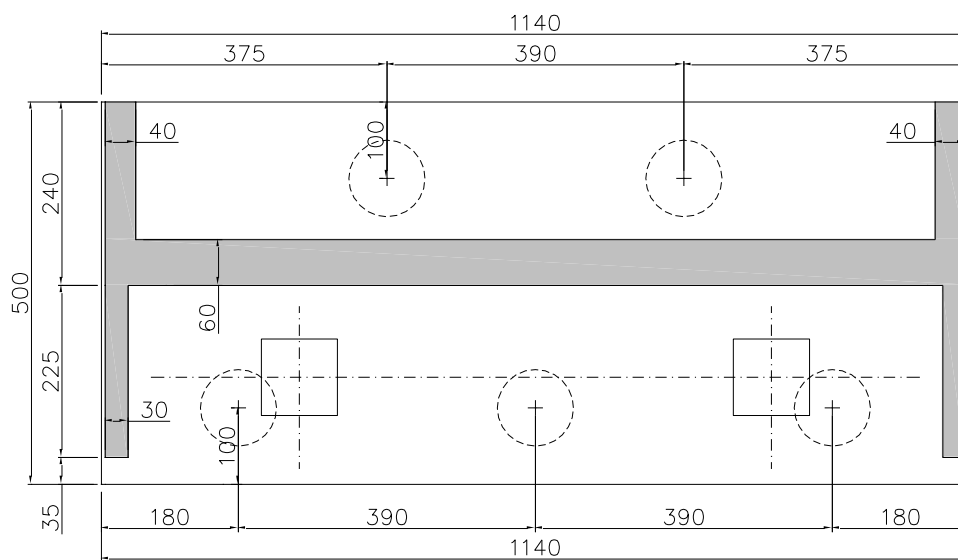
Sezione allo spiccatto del muro paraghiaia
